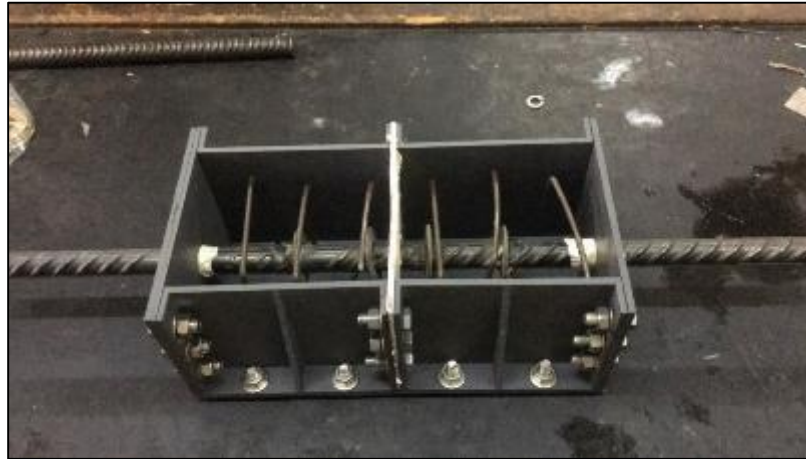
Encofrado definitivo con disposición de la armadura
